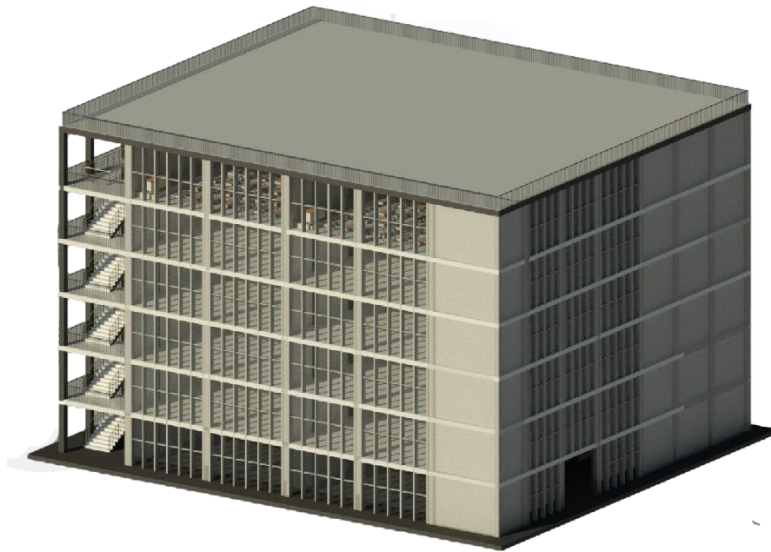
Fachada 2 de aulas del edificio. Aulas 3 y 4
